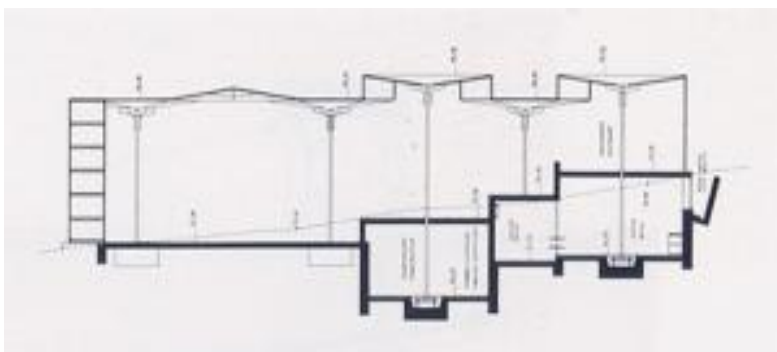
Sección transversal donde se observan cómo la estructura se adapta a los desniveles del terreno. Imagen de la revista *Informes de la Construcción*, n. 106, diciembre 1958.
